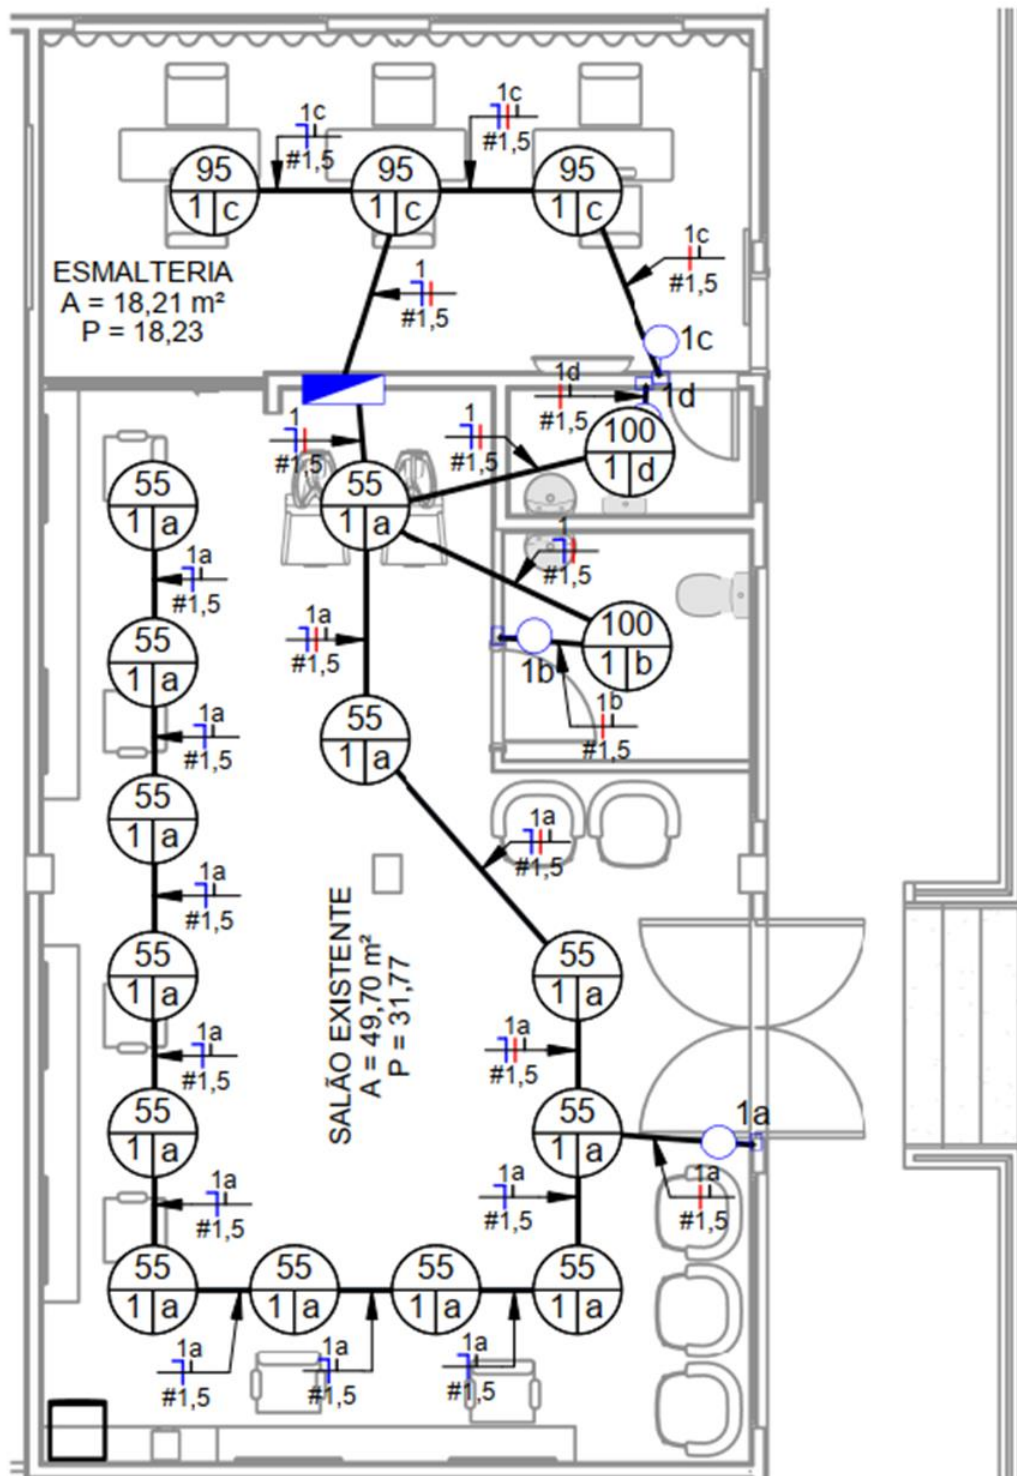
Planta Iluminação – Fonte Autor dia 15/10/2023
